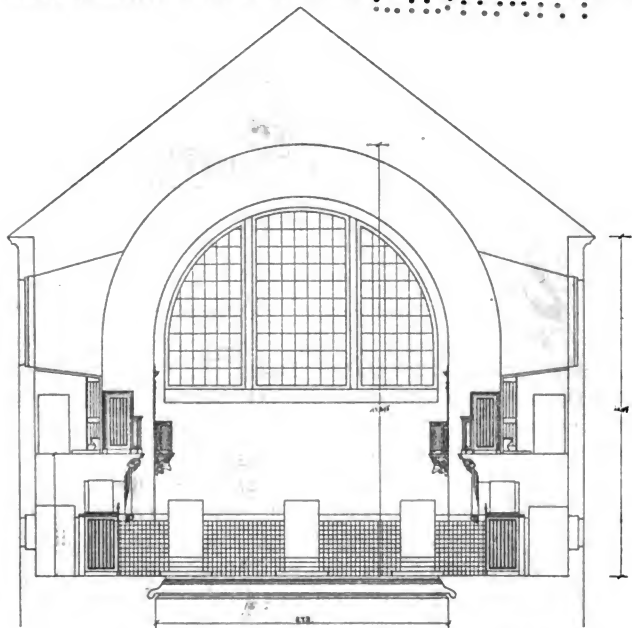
Badeanstalt in Berlin, Bärwaldstraße;
